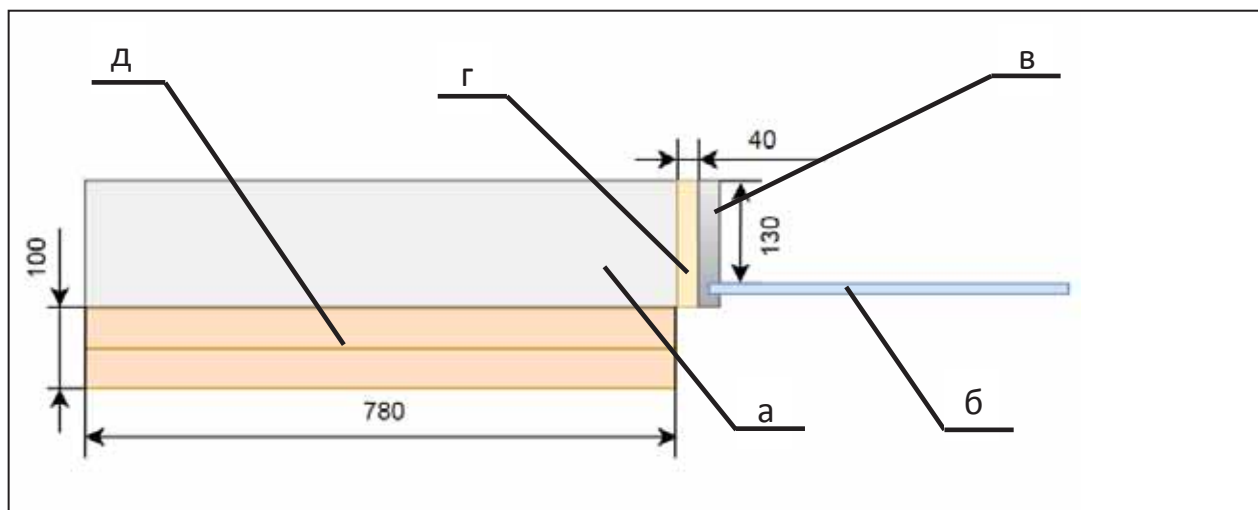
Схема узла исследуемого фрагмента. Без дефекта, утепление наружной поверхности стены 100 мм: а – стена; б – стеклопакет; в - оконный профиль; г - пенный шов; д – утеплитель.
